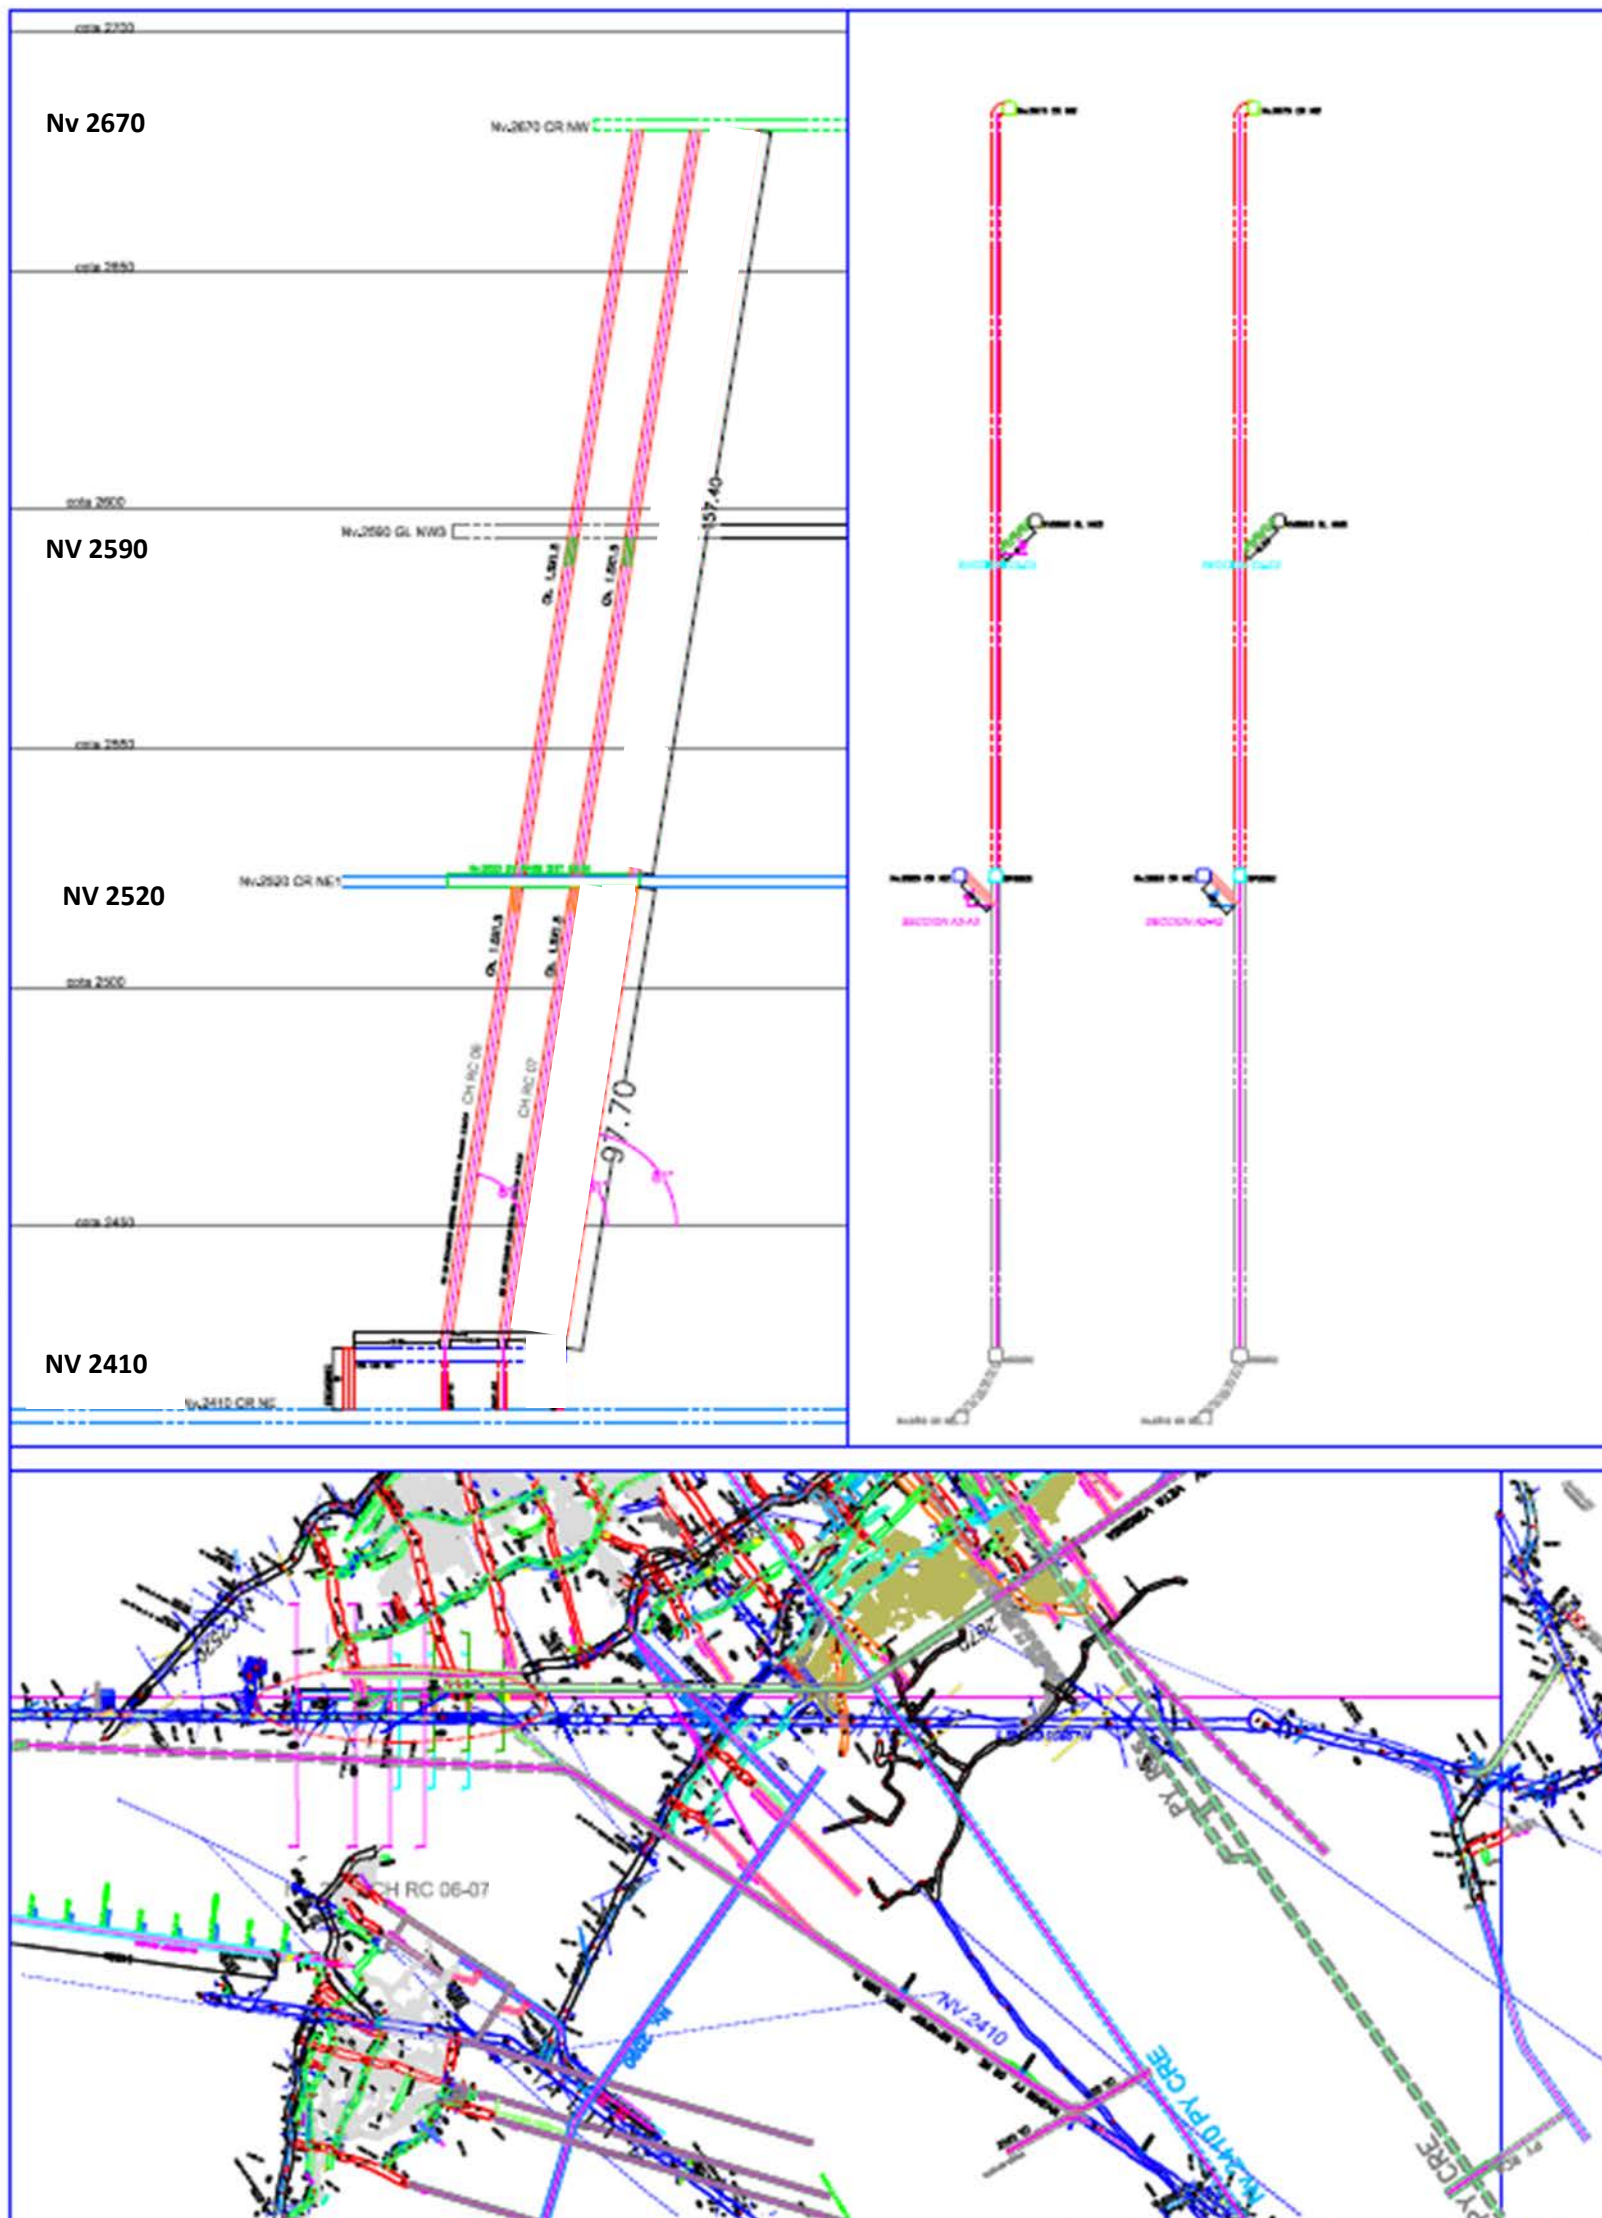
Vista de Perfil y Planta del Chimeneas *Raise Climber*.
